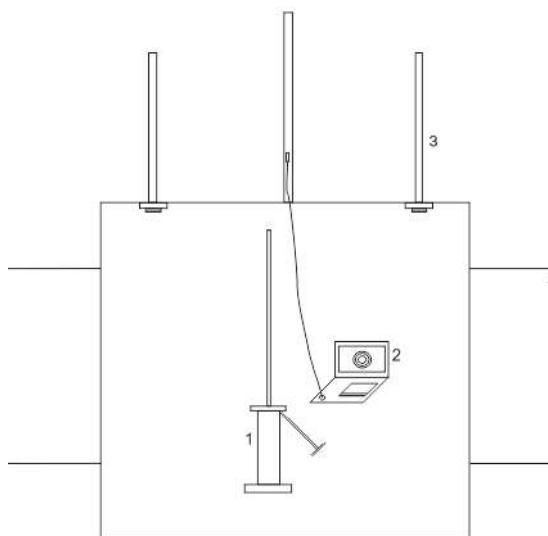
Исследования кровли выработок видеоэндоскопом
